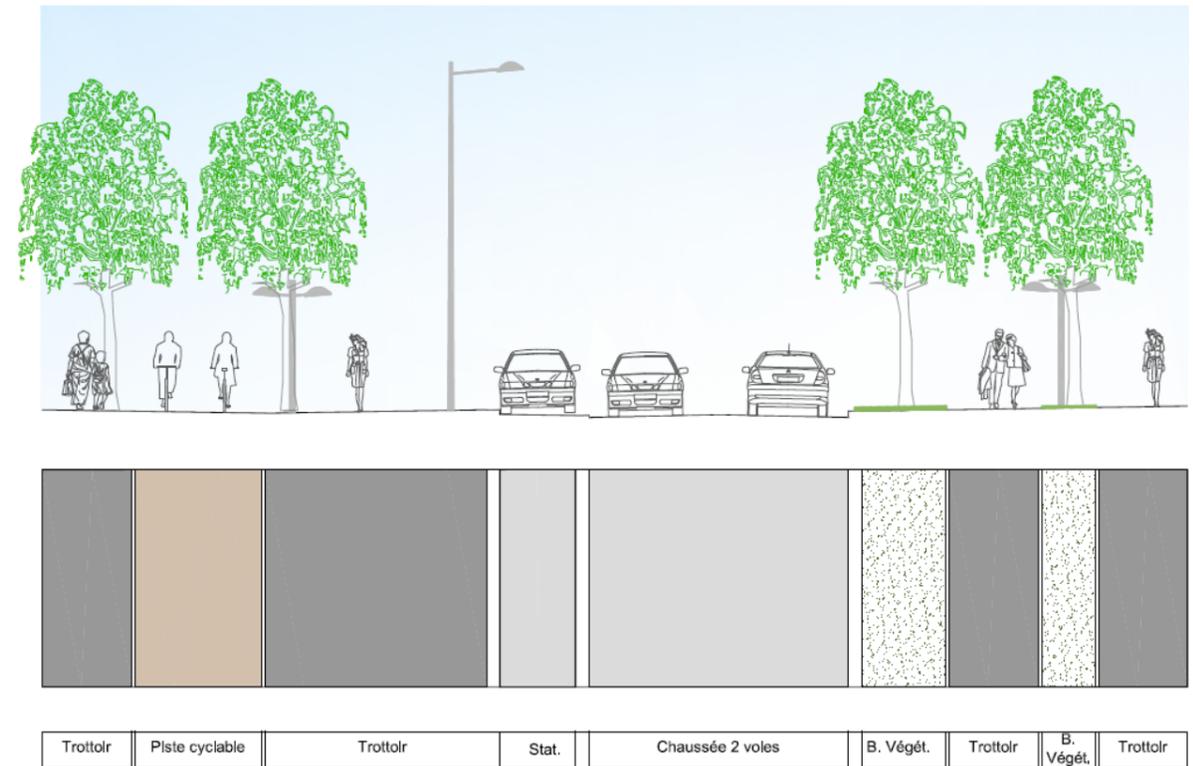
Coupe de principe sur le boulevard Sud – Section 1
